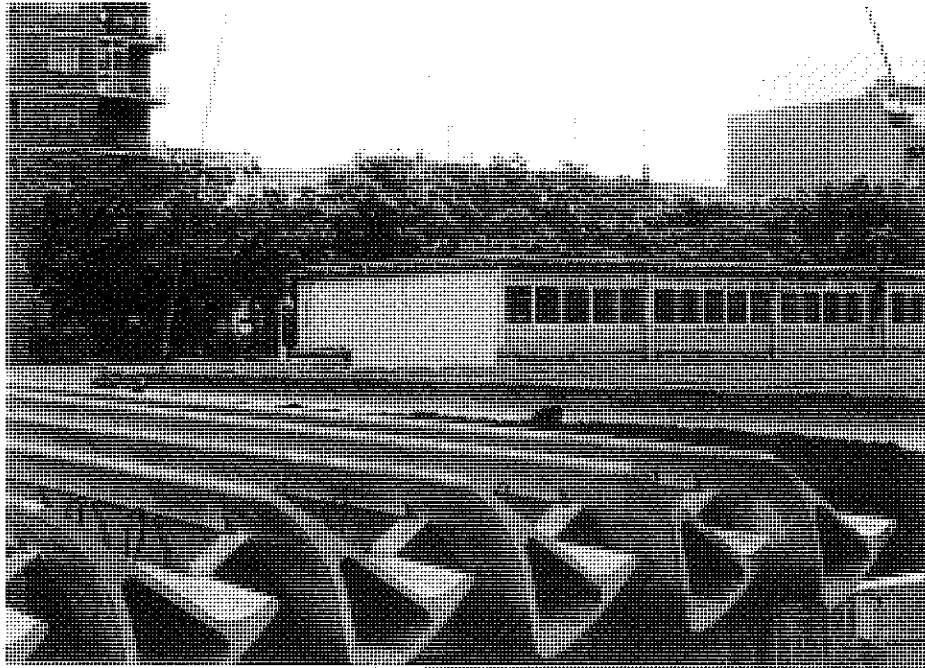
Vista de un conjunto de vigas montadas. Los espesores aparentes en el extremo del vuelo son menores que los reales en las secciones interiores de las vigas.
